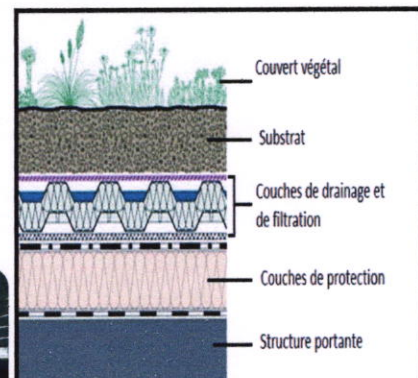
Détail d'un plancher terrasse jardin Source : www.gipen.fr
